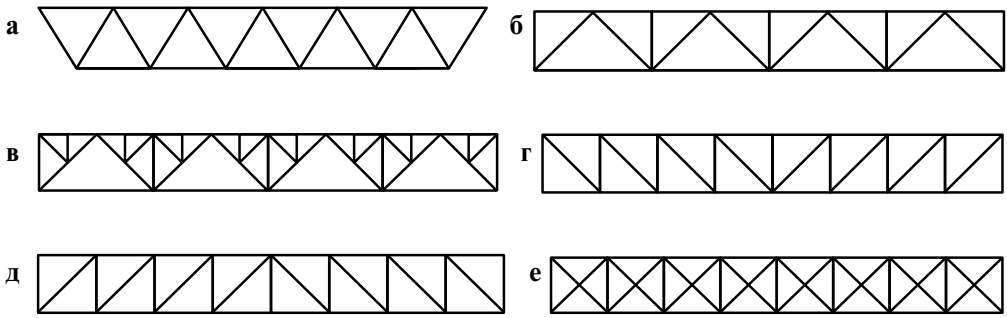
Виды ферм по очертанию поясов:
